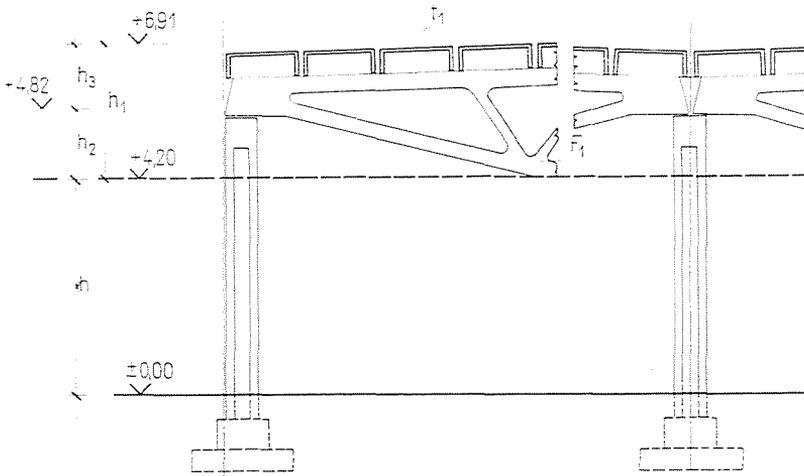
Comparaison des structures des halles industrielles 12 x 18 m, système traditionnel: F = poutre maîtresse en béton armé d'une portée de 18 m; t = panneau de couverture en béton armé d'une largeur de 1,5 m et d'une portée de 12 m; H = hauteur intérieure utile; h_2 = hauteur structurelle du système à poutre maîtresse courte; h_1 = hauteur structurelle du système traditionnel; h_3 = épargne en hauteur structurelle
